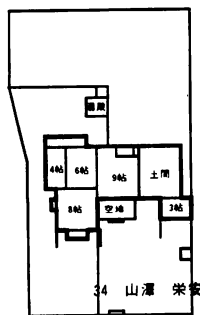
享保6年所司代下屋敷絵図の小型住宅平面図
